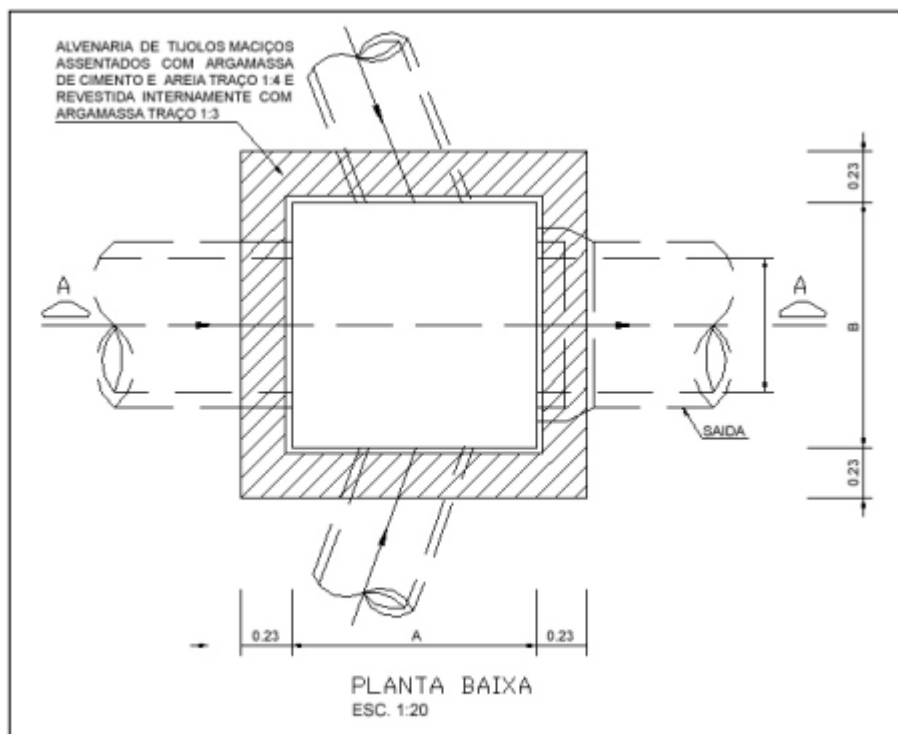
Poço de Visita com Chaminé Planta Baixa.
